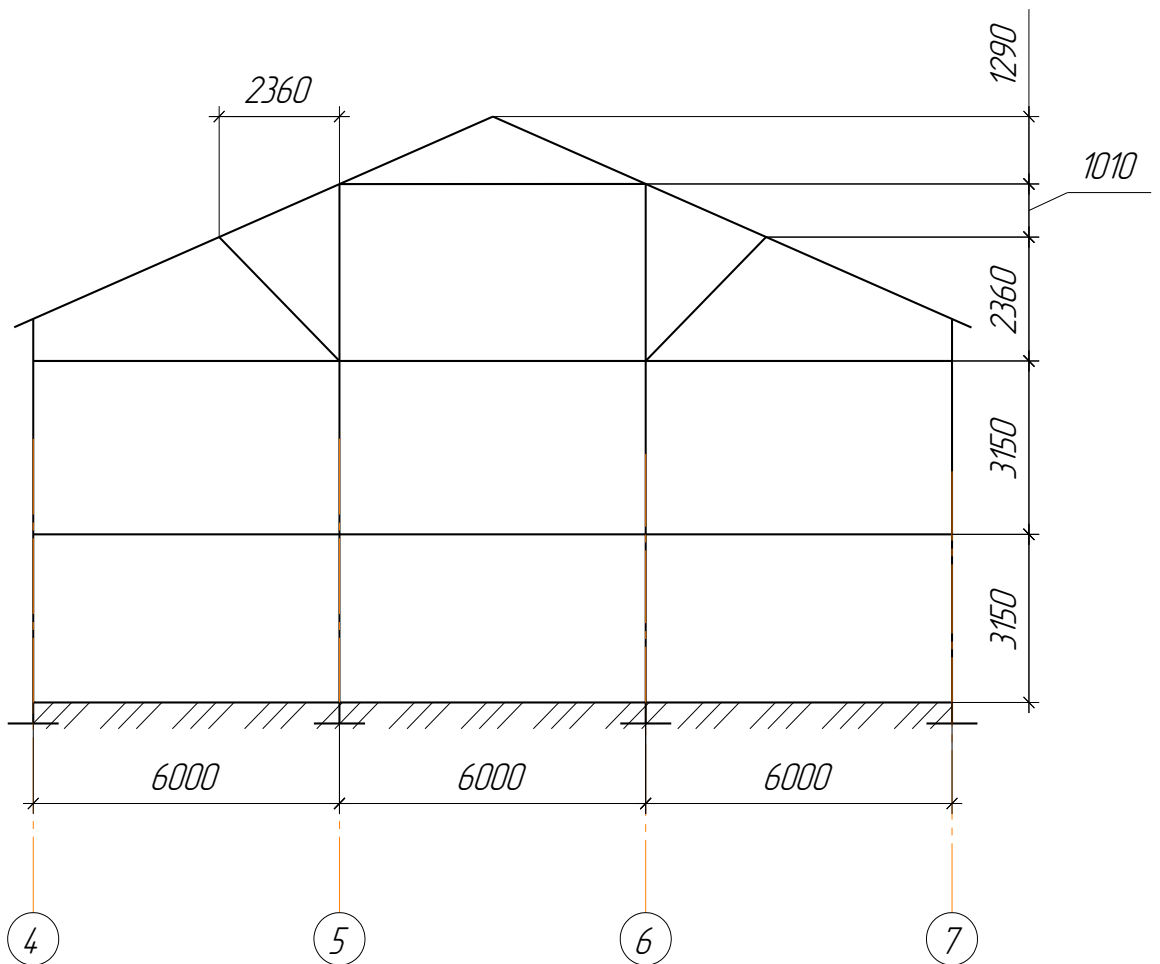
Схема поперечного разреза здания в осях 4-7
